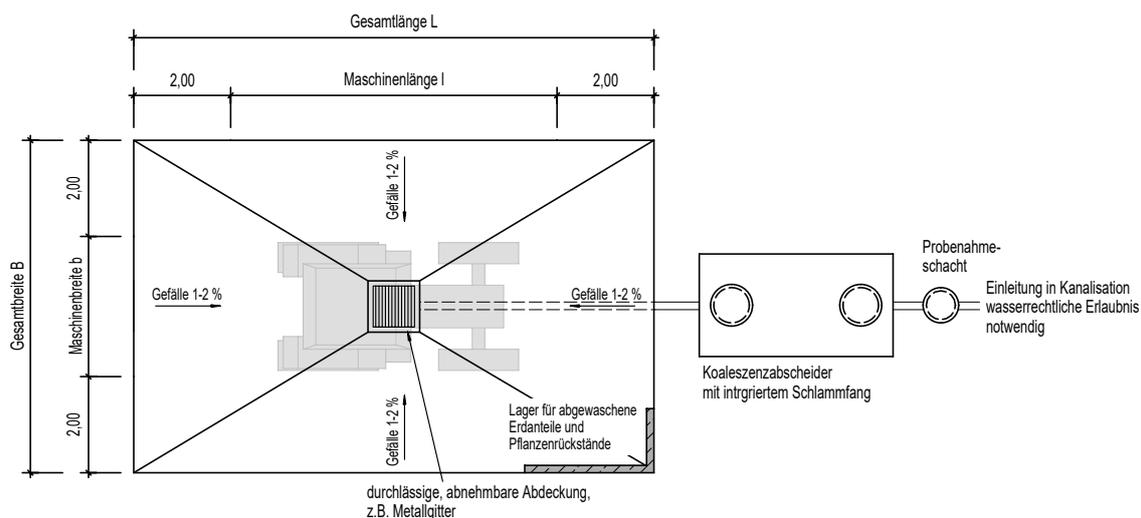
Ein Waschplatz im Grundriss (LWK NRW 2024)
